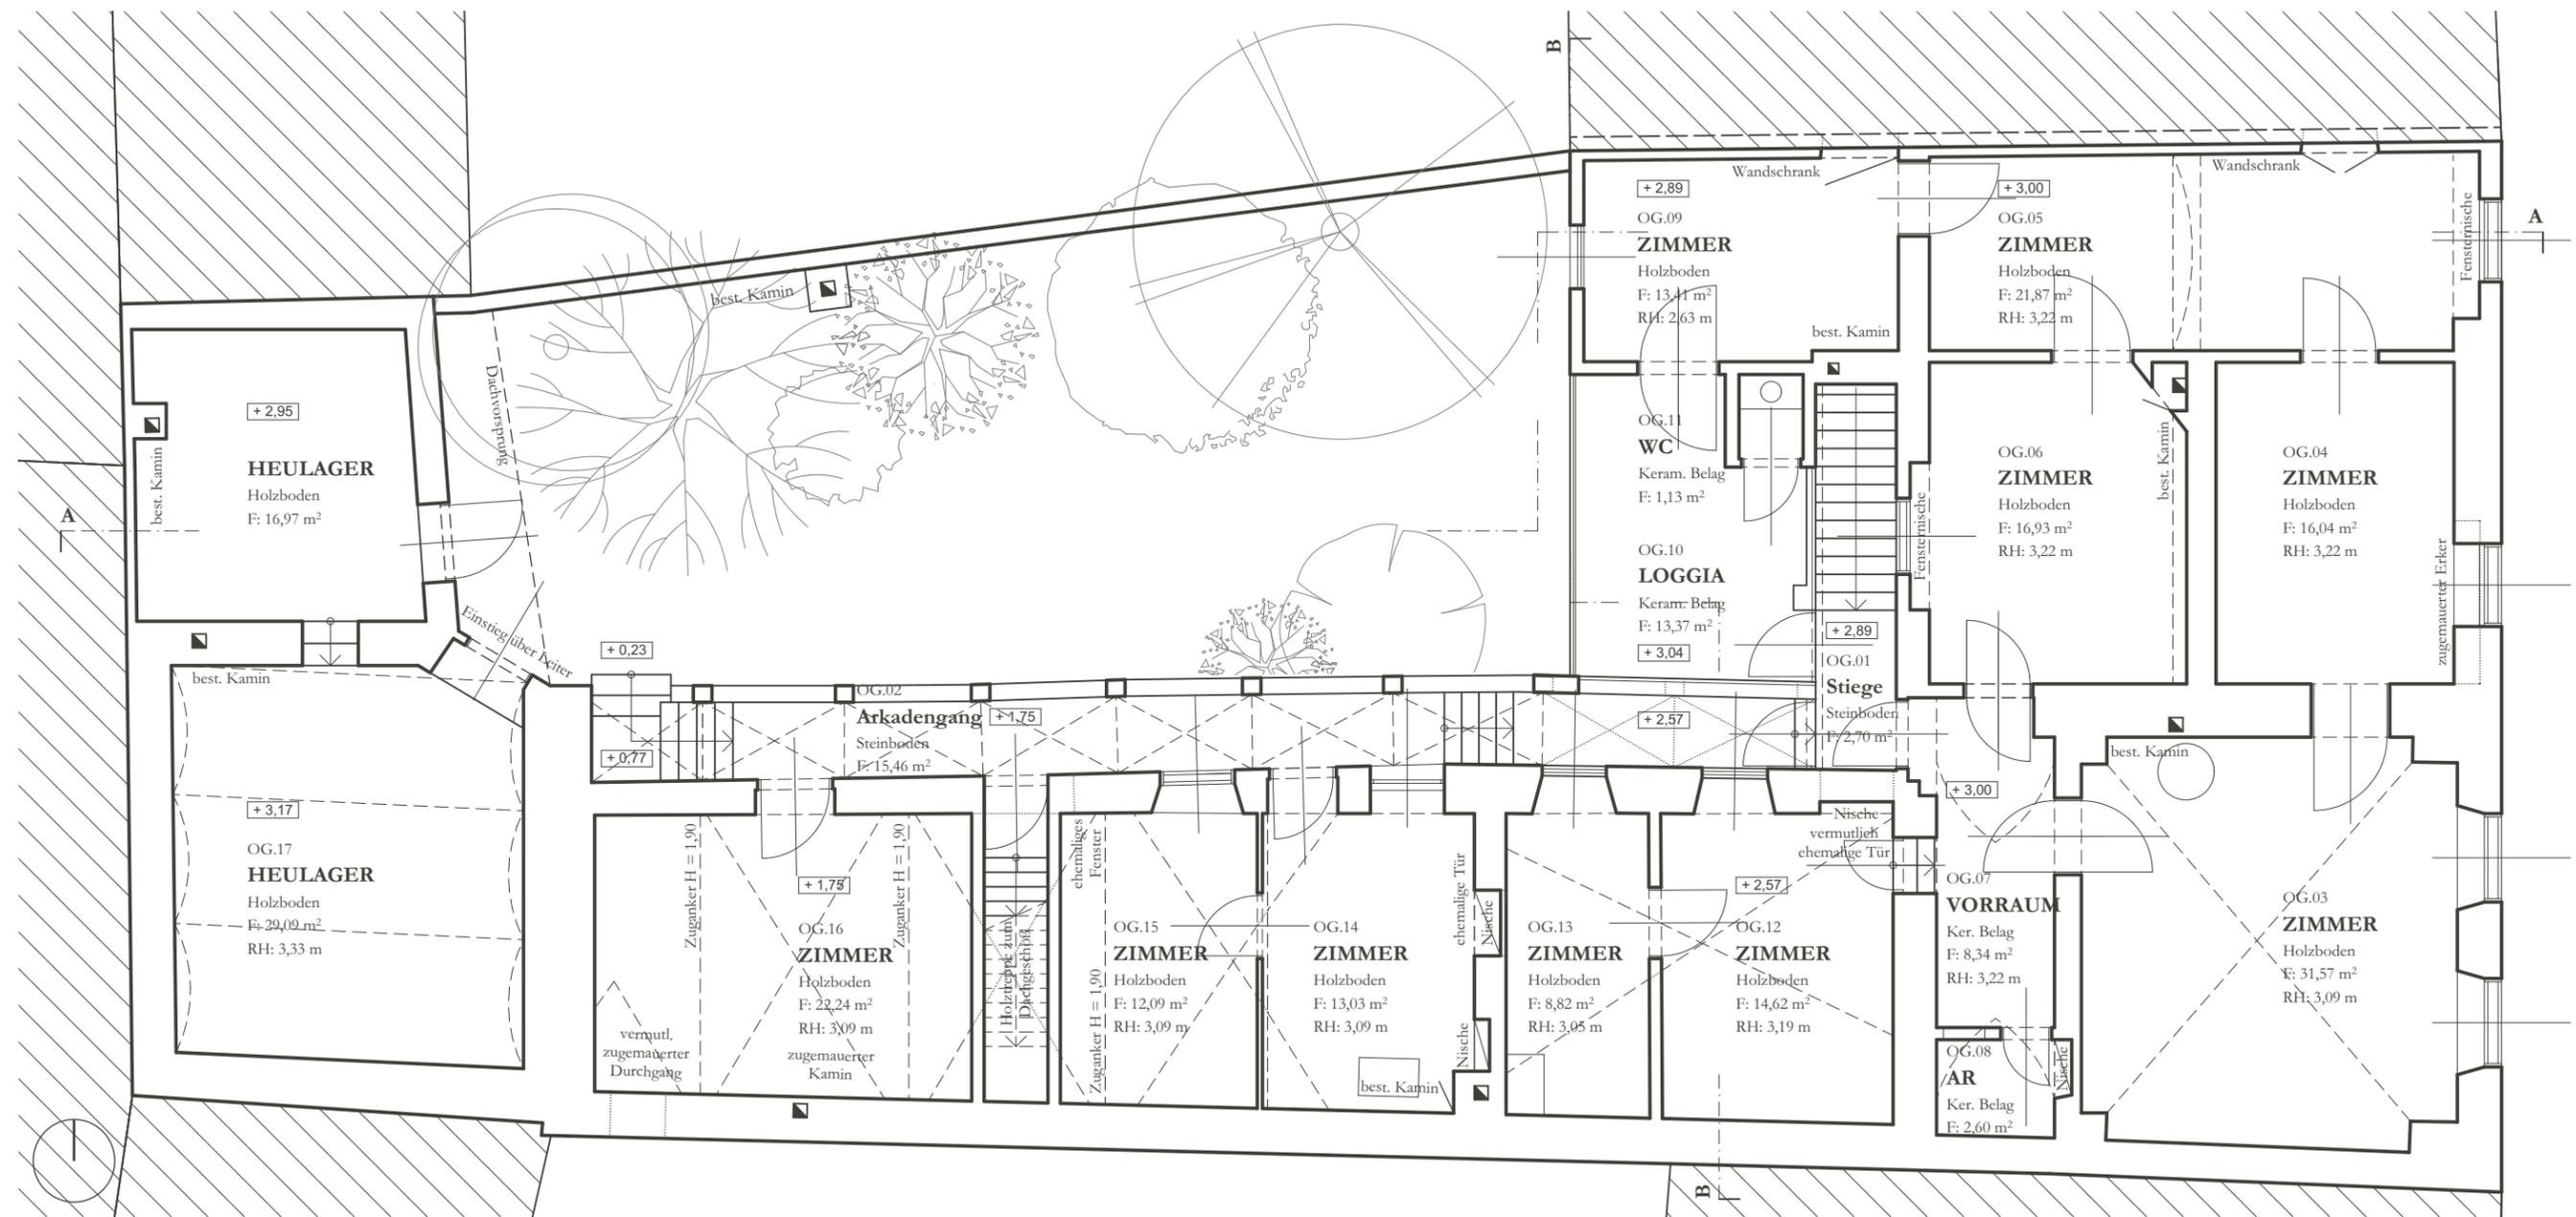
Bestandsplan Obergeschoß, M 1:100
